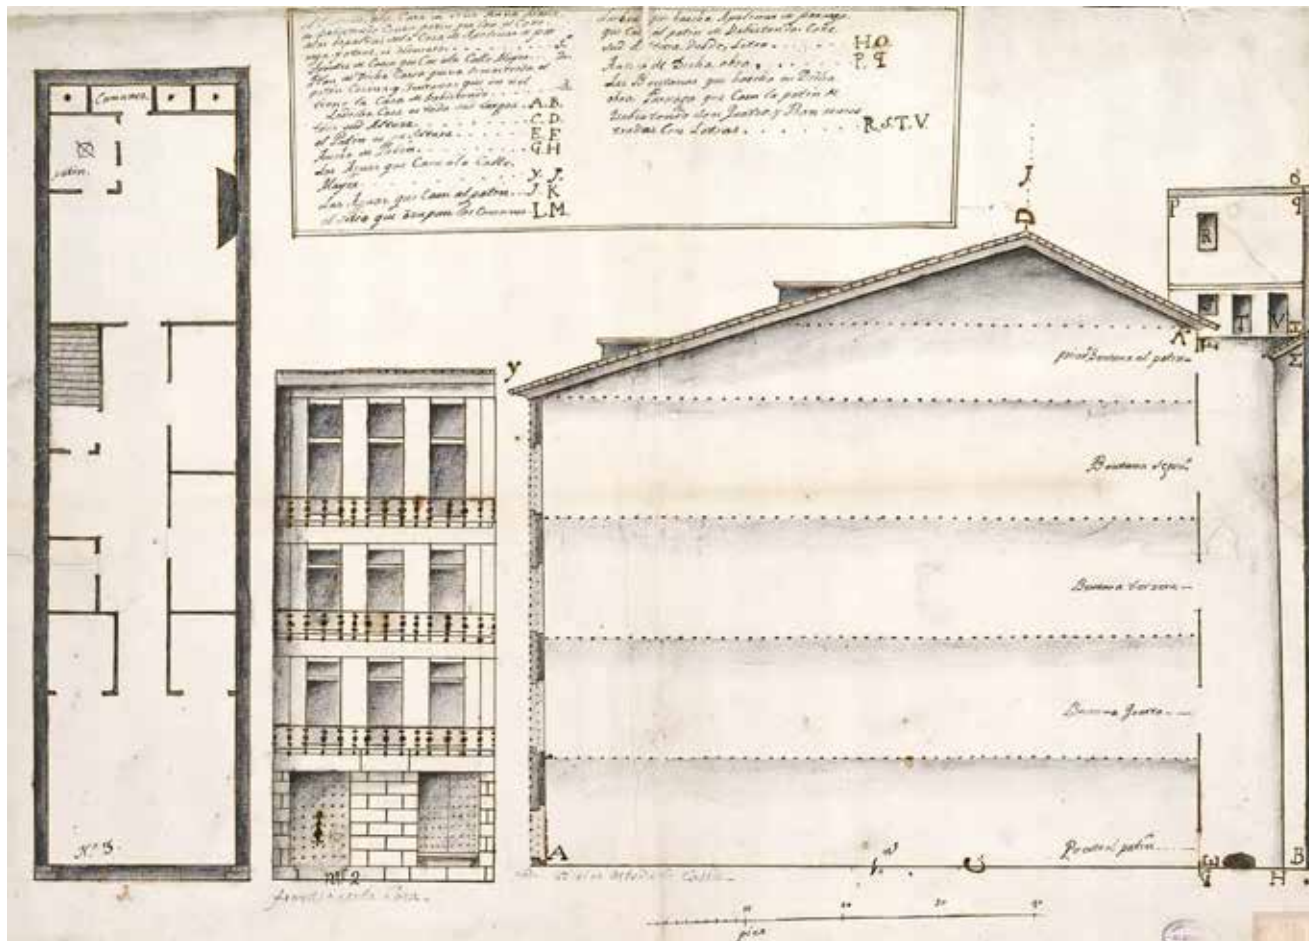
P. Arbiza, dibujo de Planta, Alzado y Sección de la casa de A.M. Urbiztondo que da a la calle Mayor, 1784, A.R. Chancillería de Valladolid, PyDD 65.
